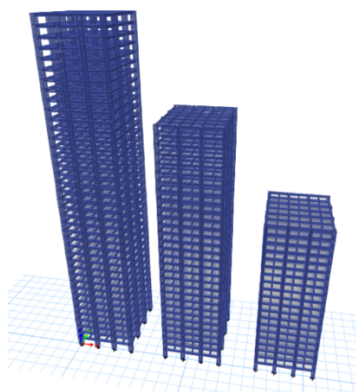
Vista en 3D de las estructuras a analizar. Modelo en ETABS
